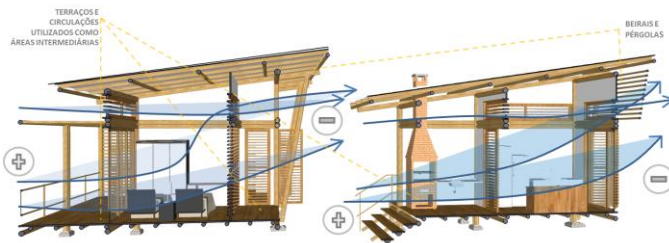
Corte esquemático, casa térrea, aplicação de estratégias bioclimáticas ao projeto.
